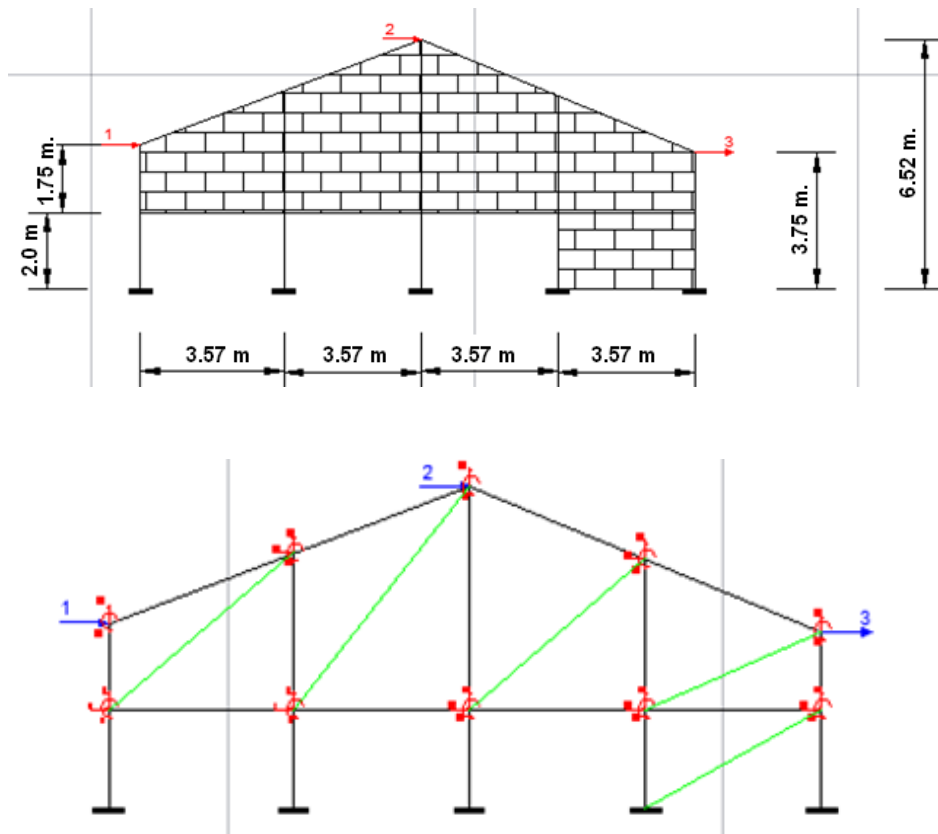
Pórtico 5, exterior de hormigón armado.
